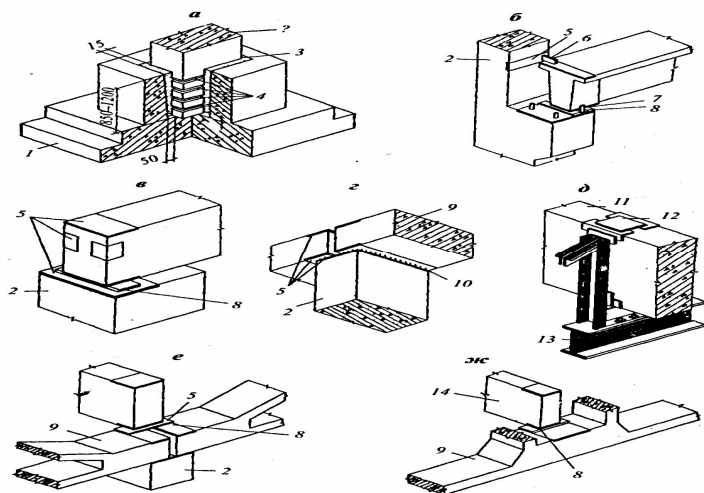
Узлы железобетонного каркаса одноэтажных промышленных зданий:
